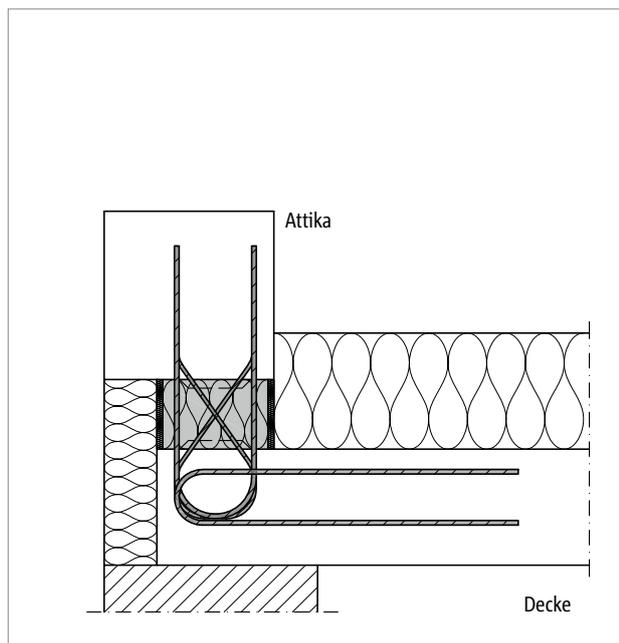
Schöck Isokorb® XT Typ A: Anschluss einer Attika (XT Typ A-MM1)
